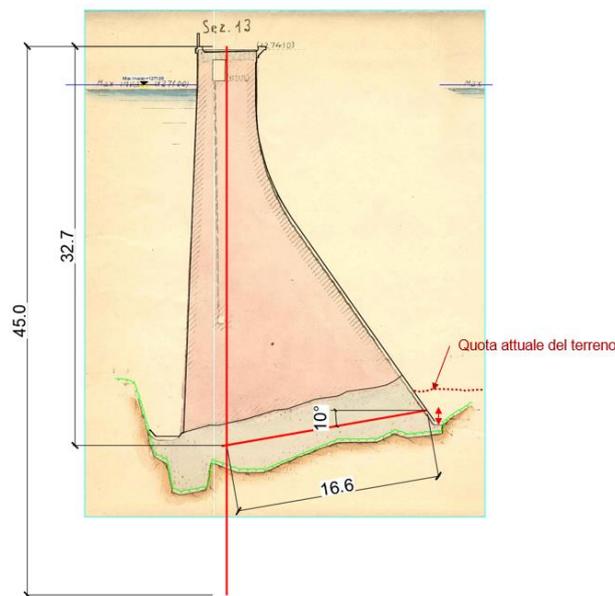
Sezione con ubicazione dei drenaggi di prova
